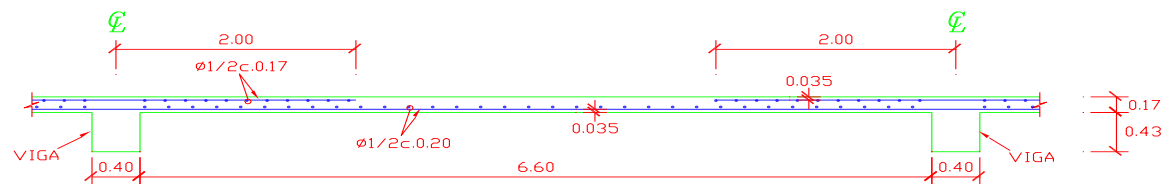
Detalles del refuerzo longitudinal de la losa maciza.
